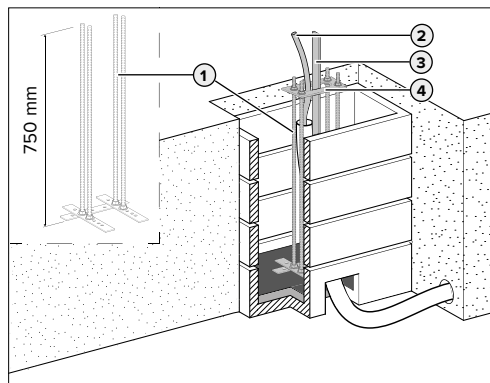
Set di fissaggio per fondazione e piastra di fondo MENNEKES
